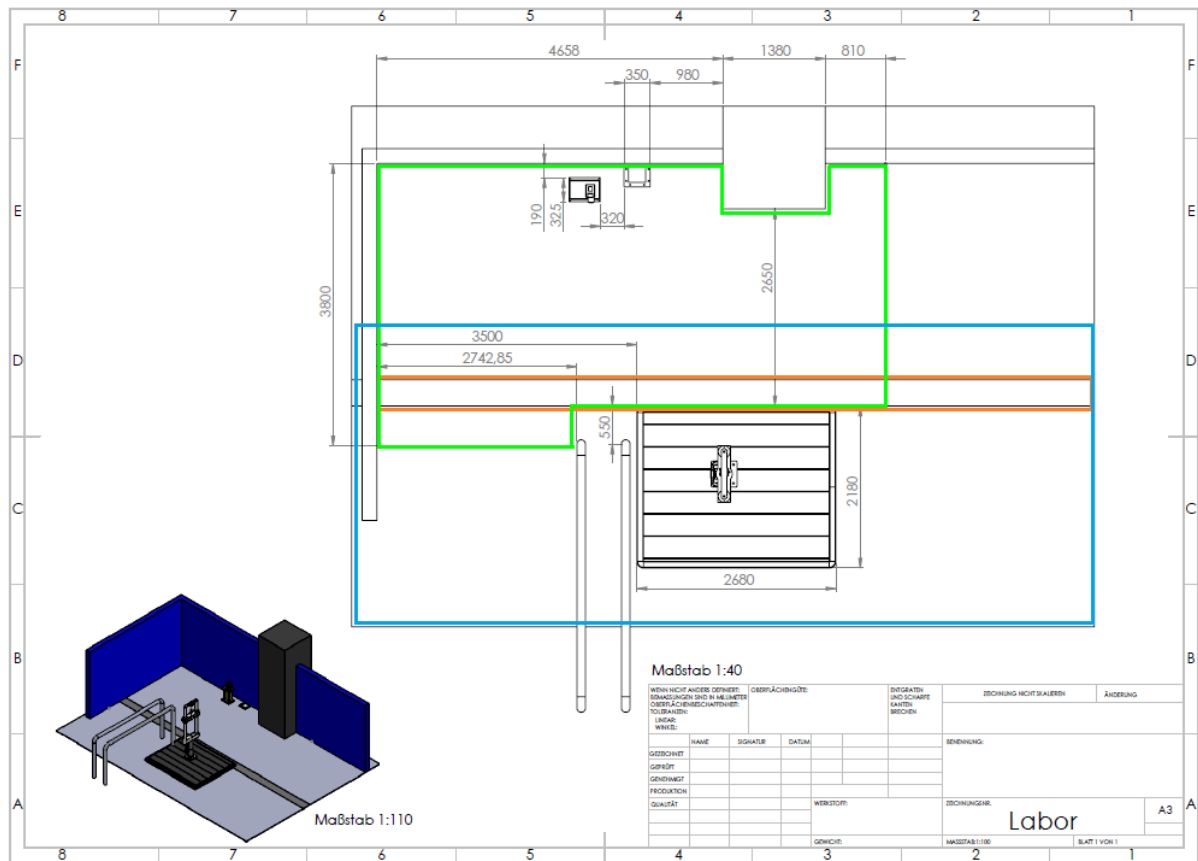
Grundriss Laborbereich mit Begrenzungen
